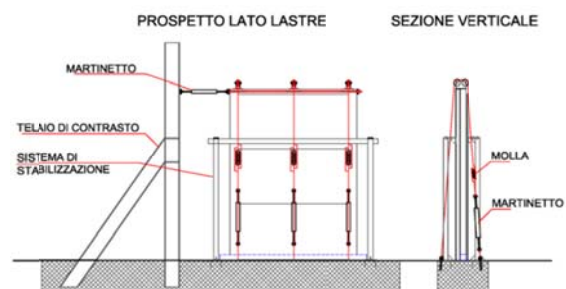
Allestimento della prova – prospetto e sezione verticale.
